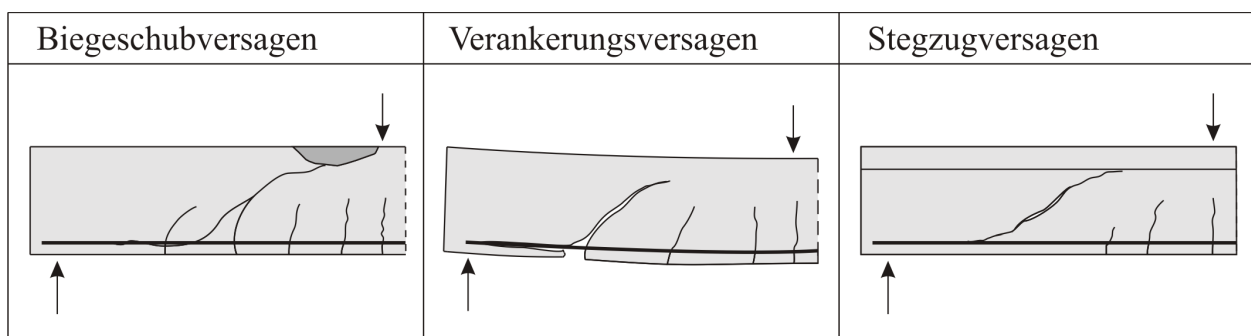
Klassische Versagensarten bei Stahlbetonbalken ohne Schubbewehrung unter Einzellasten, nach [Zilch u. Zehetmaier (2010)]
